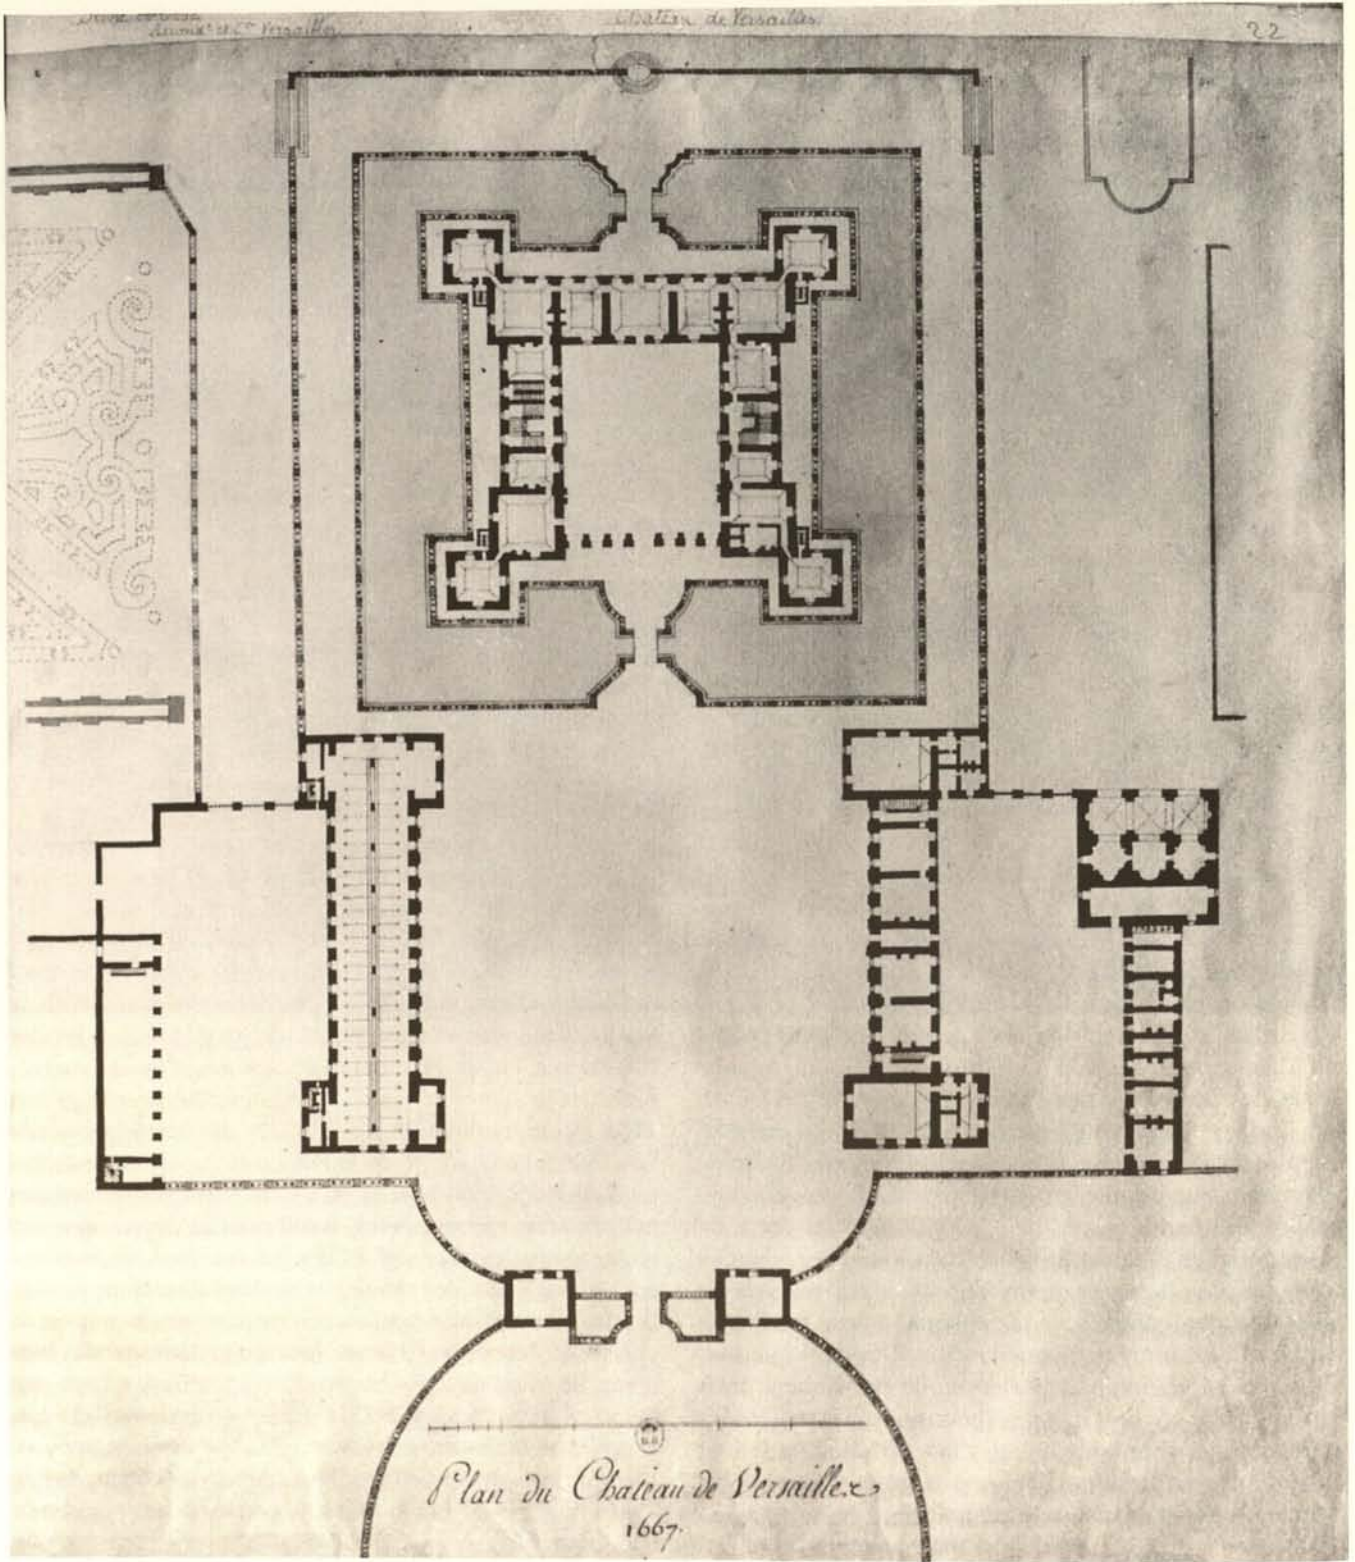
Schloß Versailles 1667, Gesamtplan mit Grundriß des Erdgeschosses
